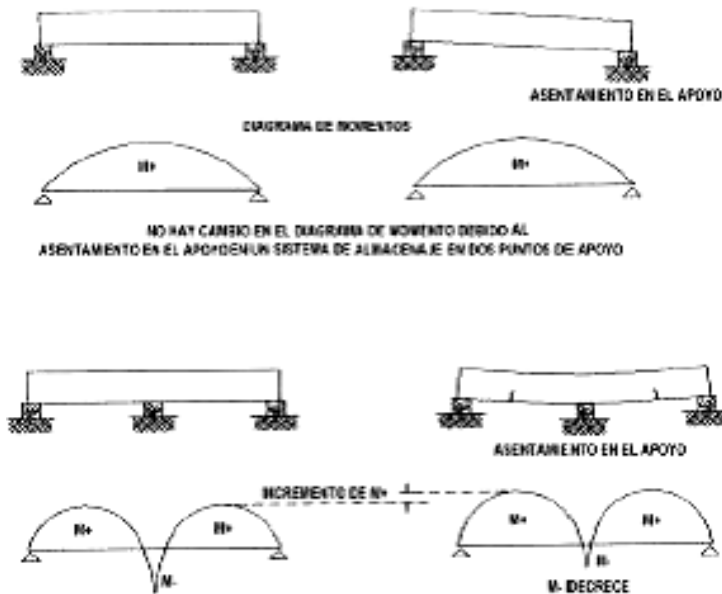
Esquema de las condiciones de almacenaje en elementos presforzados
